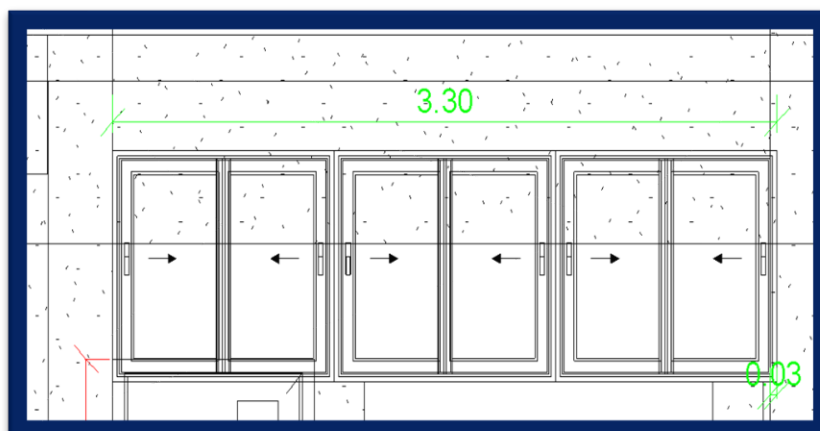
Interferencia en V-2 y Columna C-4 (Vista alámbrica).
